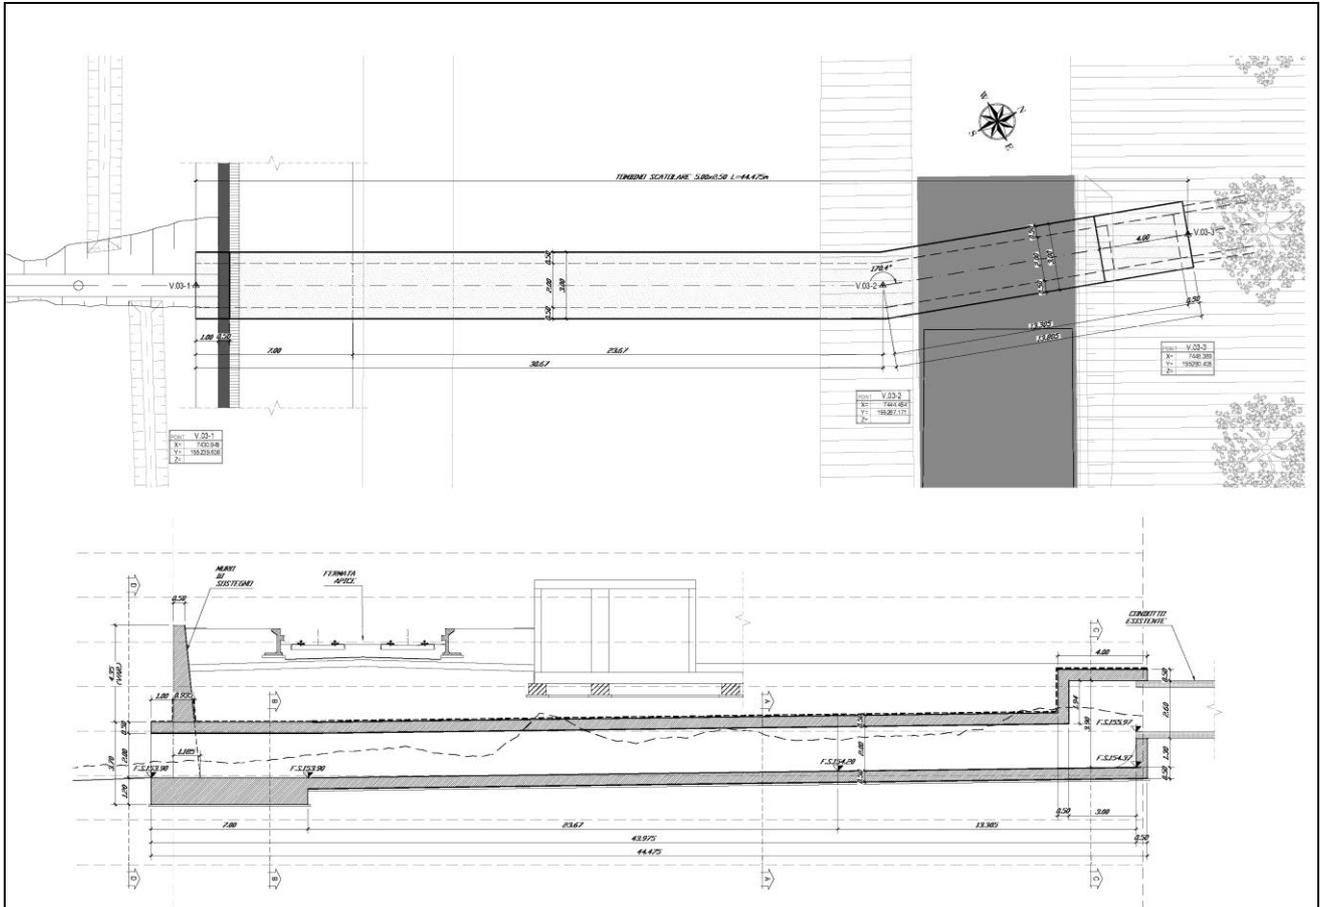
Inalvezione IN03 – Pianta e sezione longitudinale
